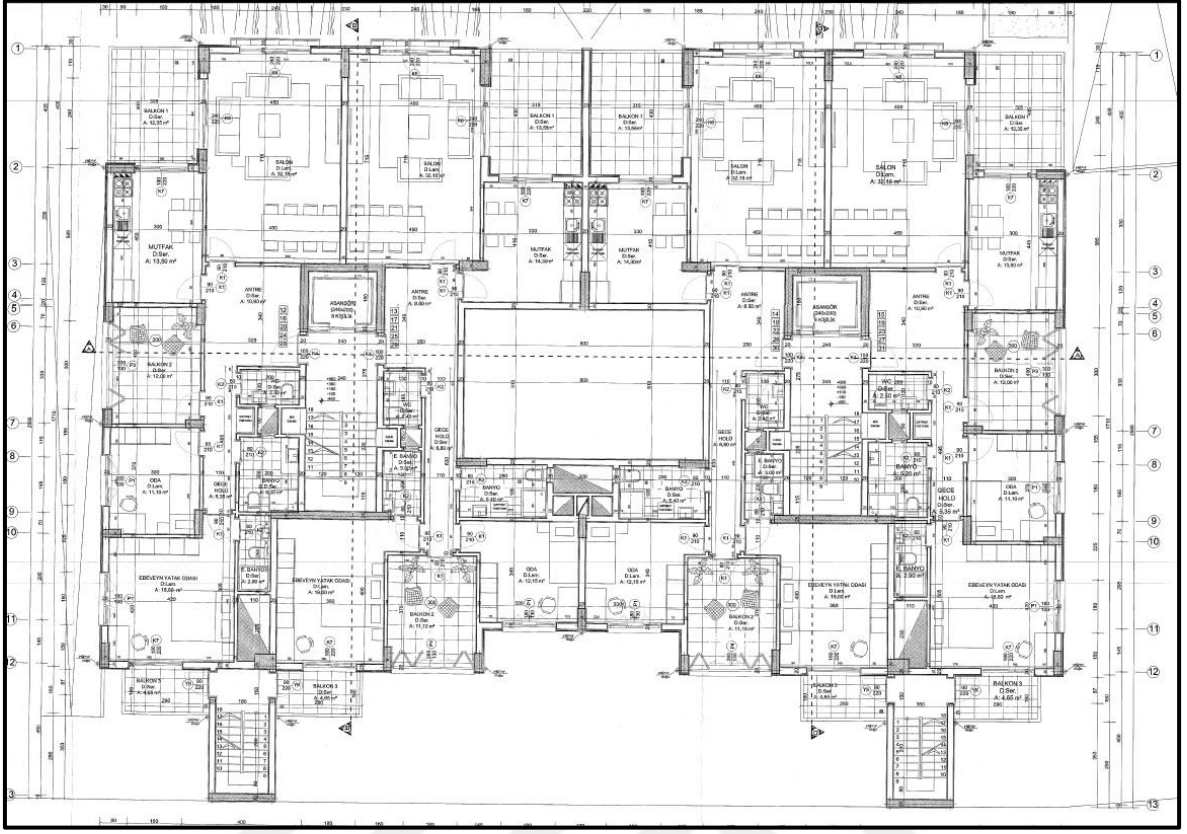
4. Örneğe ait arsa üzerinde yapı ruhsatı alınan mimari projeye ait vaziyet planı
